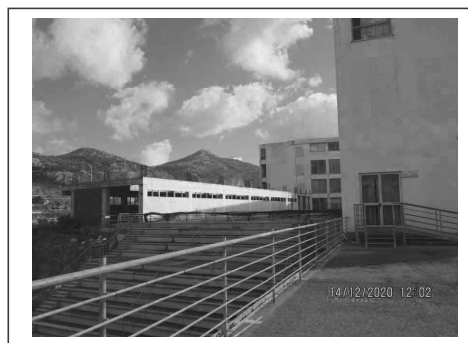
Edifici facenti parte del complesso scolastico disposti attorno ad una corte comune. L'edificio più basso (sub. 14) è oggetto di pignoramento
